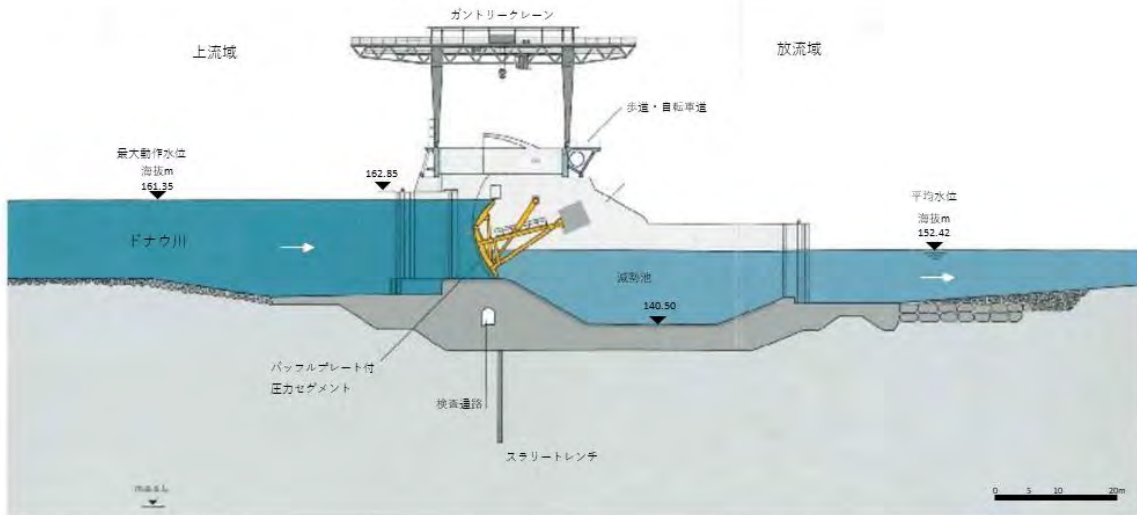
洪水調節ゲート部の断面図(パンフレットより)
